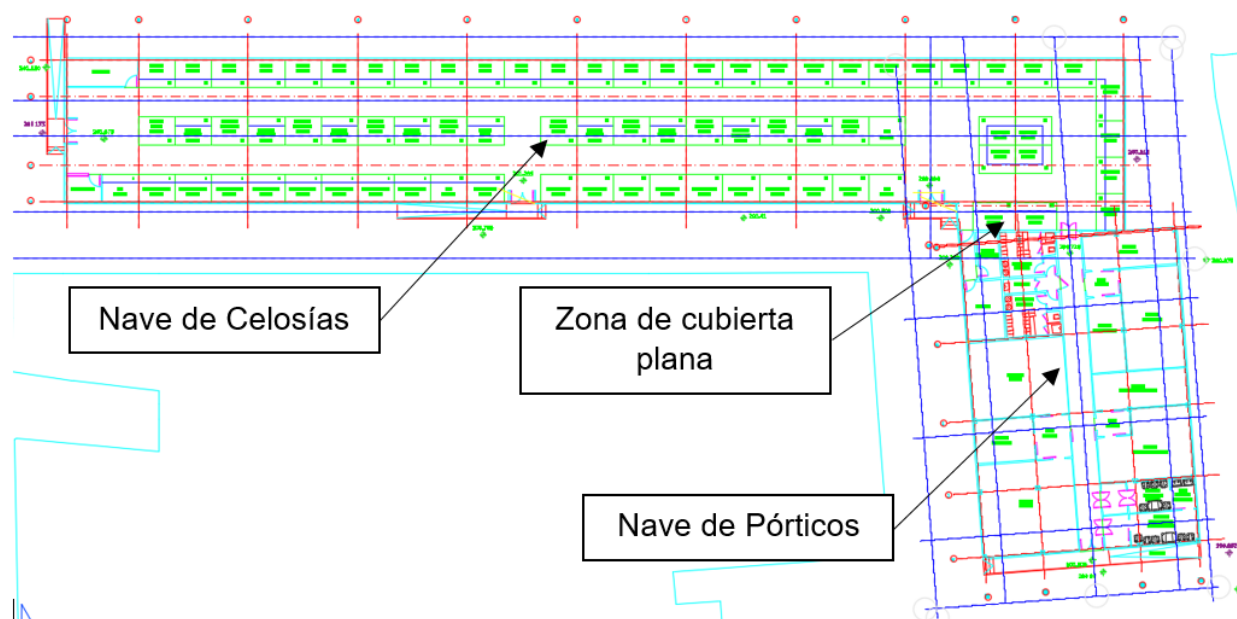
Planta de arquitectura del Mercado Provisional.
